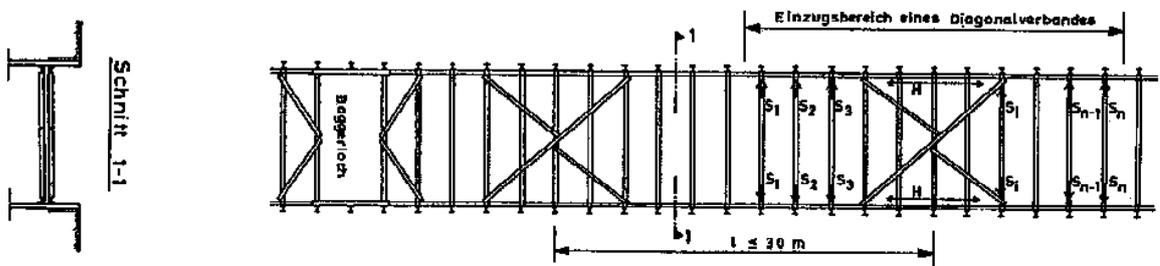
Rammträger- und Mittelträgerstützenaussteifung
